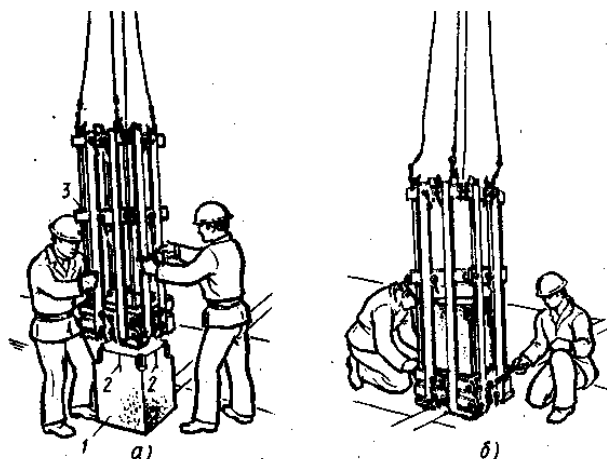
Установка (а) и закрепление (б) кондуктора на оголовке
